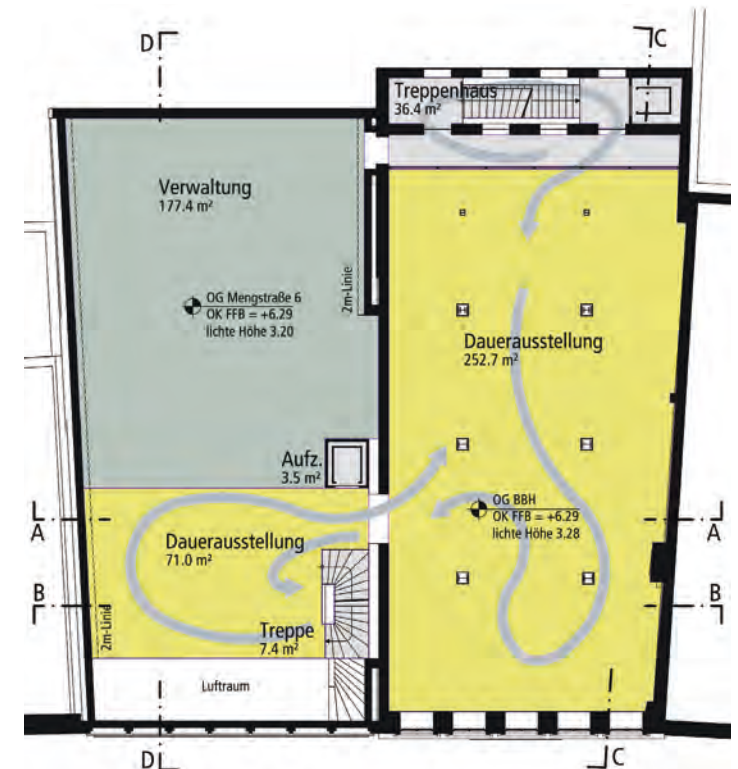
Variante 1, Grundriss 1. Obergeschoss
